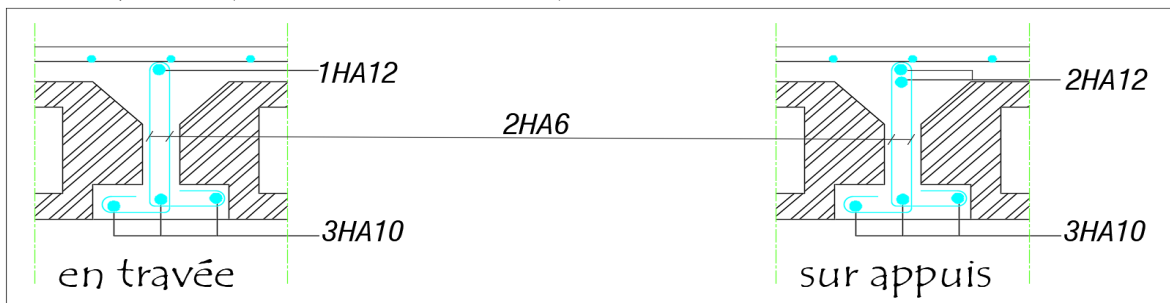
Schéma de ferrailage de la poutrelle (plancher terrasse)
